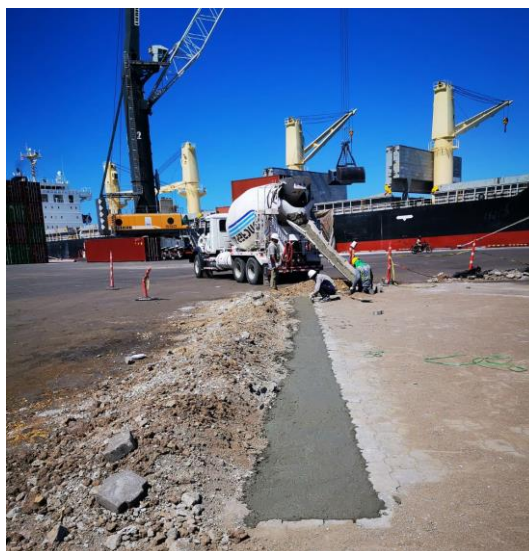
Trabajos viga confinamiento y aplicación arena para juntas adoquines
